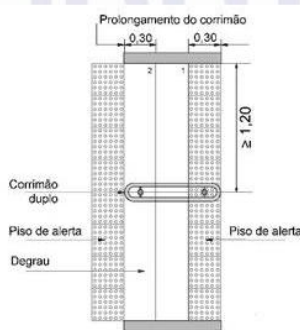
Corrimão intermediário com duas alturas em degrau isolado com dois degraus em planta – Exemplo
